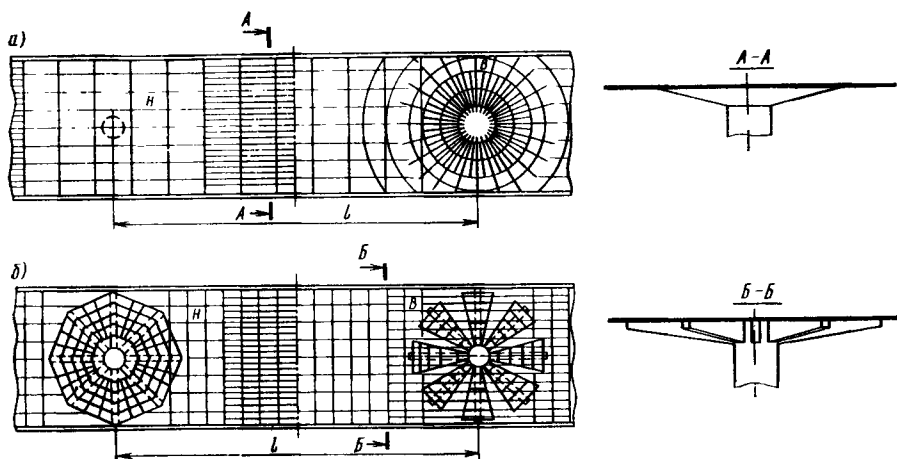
Схемы армирования ненапрягаемой арматурой пролетных строений переменной толщины:
